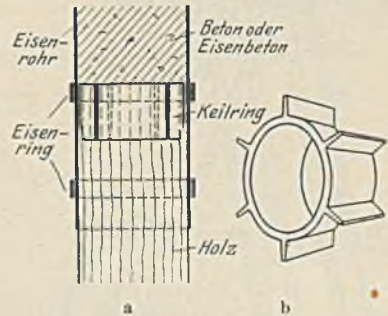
Verbindung zwischen Holzpfählen und Betonpfählen bei der Bauweise Heimbach.
